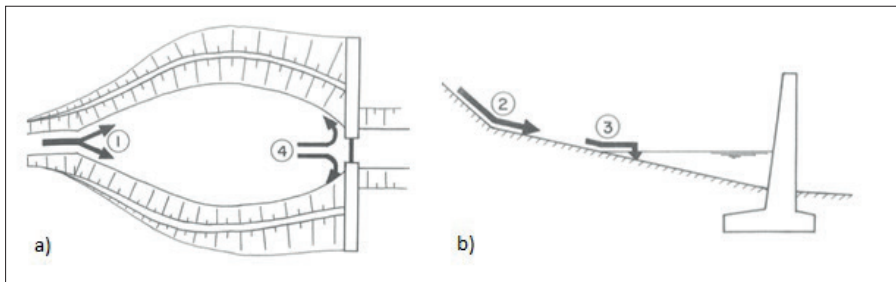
Ablagerungsmechanismen in einem Geschiebesammler im Grundriss a) und Schnitt b): Gerinneaufweitung (1), Gefällsknick (2), Wasseraufstau (3), direkte Behinderung des Geschiebetriebs durch Abschlussbauwerk (4) (Zollinger 1983).
